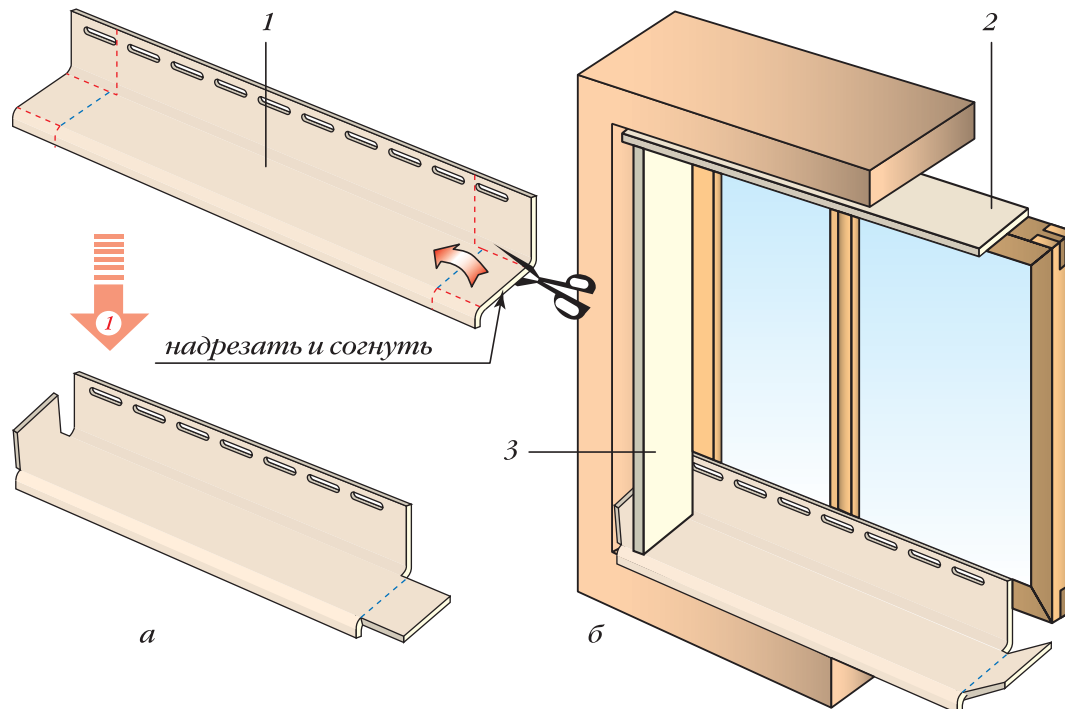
Установка винилового отлива: а — подрезка отлива; б — откосы в сборе; 1 — отлив; 2 — верхний откос; 3 — боковой откос
